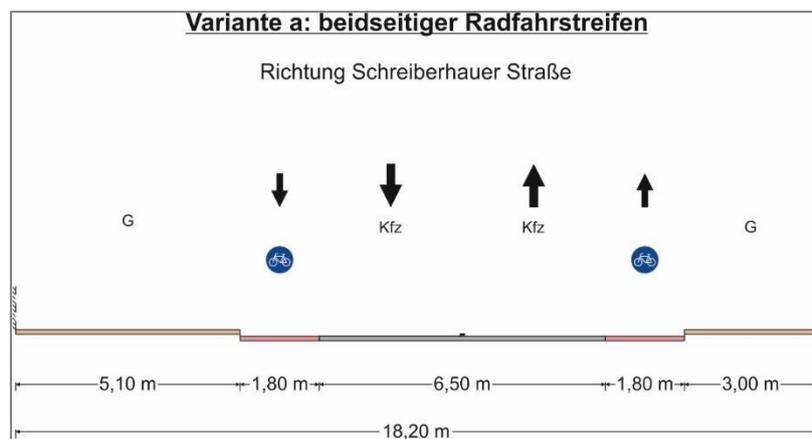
Variante a: Querschnitt Schreiberhauer Straße / Hauffstraße
